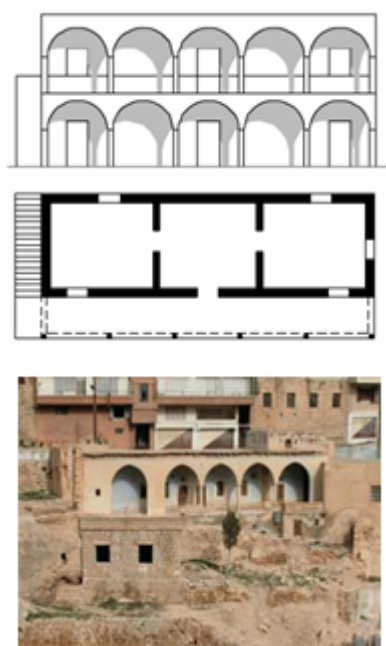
Em cima: Planta e alçado da casa do Riwaq;
